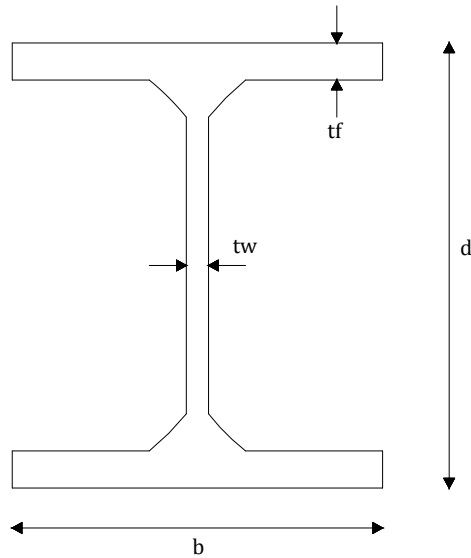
Baja Profil Wide Flange(WF)
